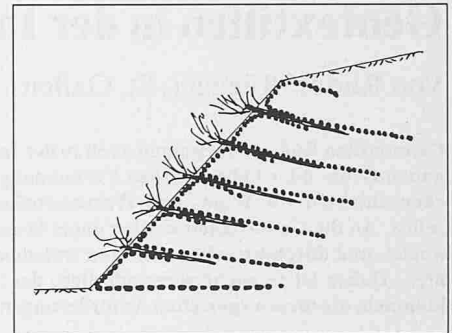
Aufbau einer begrünten geotextilmarmierten Polsterwand; Begrünung: – Einbau von Busch- bzw. Heckenlagen; – Anspritzsaat auf Geotextiloberfläche; Aufgabe des Geotextils: Armieren des Erdkörpers, Filtern (Erosionsschutz an der Oberfläche); Geotextilart: feinporig, hohe Festigkeit; Funktionsdauer: permanent
